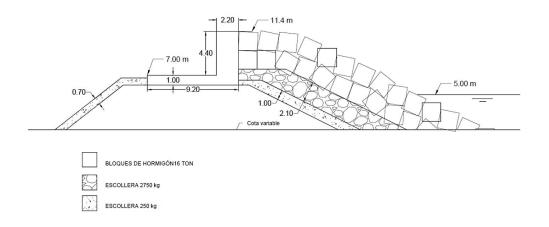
Sección 2 del dique/ Main breakwater 2nd section.
